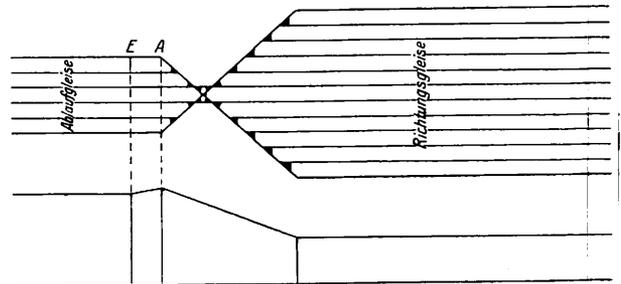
Grundriss und Längsprofil einer Ablaufanlage mit dem Abrollpunkt innerhalb der Ablaufgleise.
